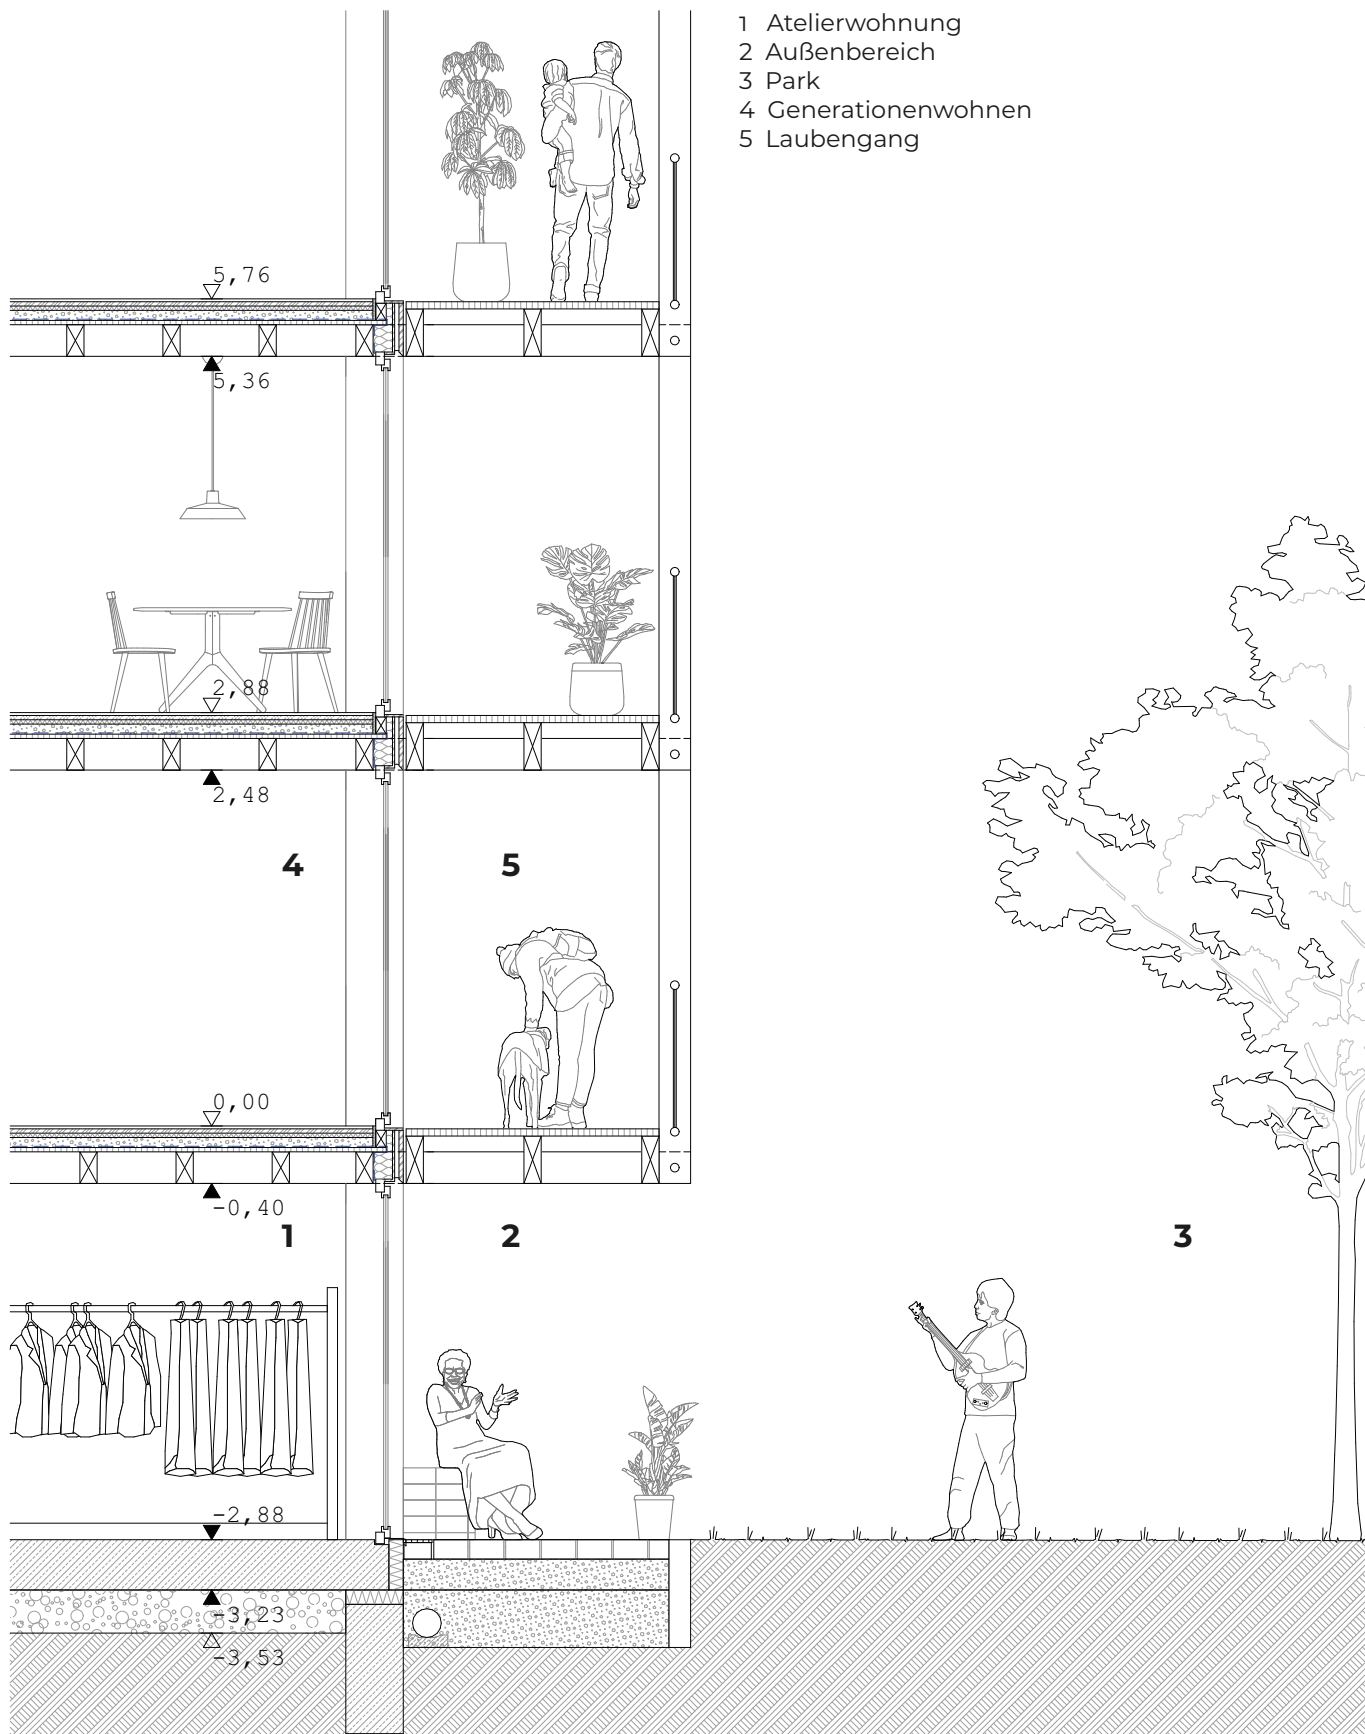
| Fassadenschnitt Aussentreppe 1:50
